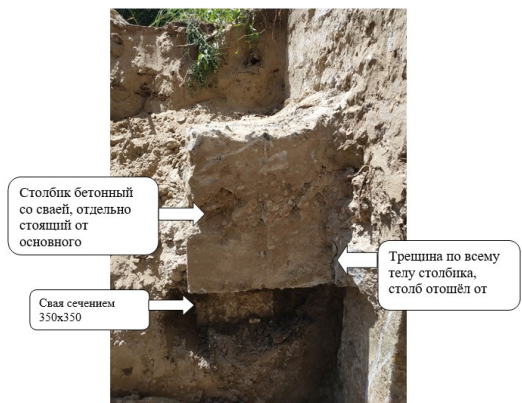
Столбик со свай, отдельно стоящего от основного фундамента здания
